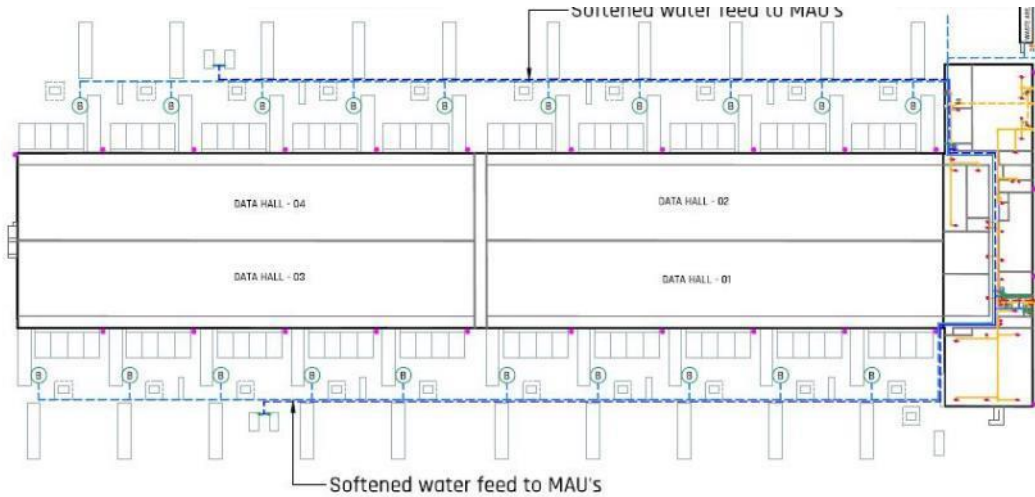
Impianto idraulico degli edifici in progetto – piano terra
